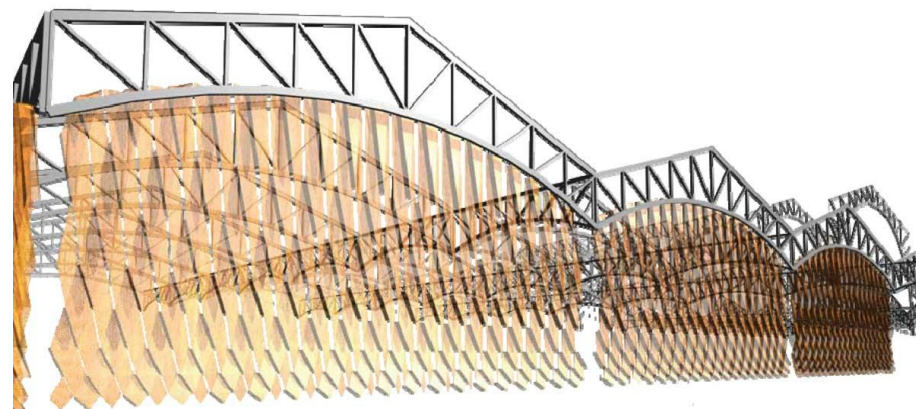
Sección del Mercado, recuperado de ArchDaily, el 23/11/22
